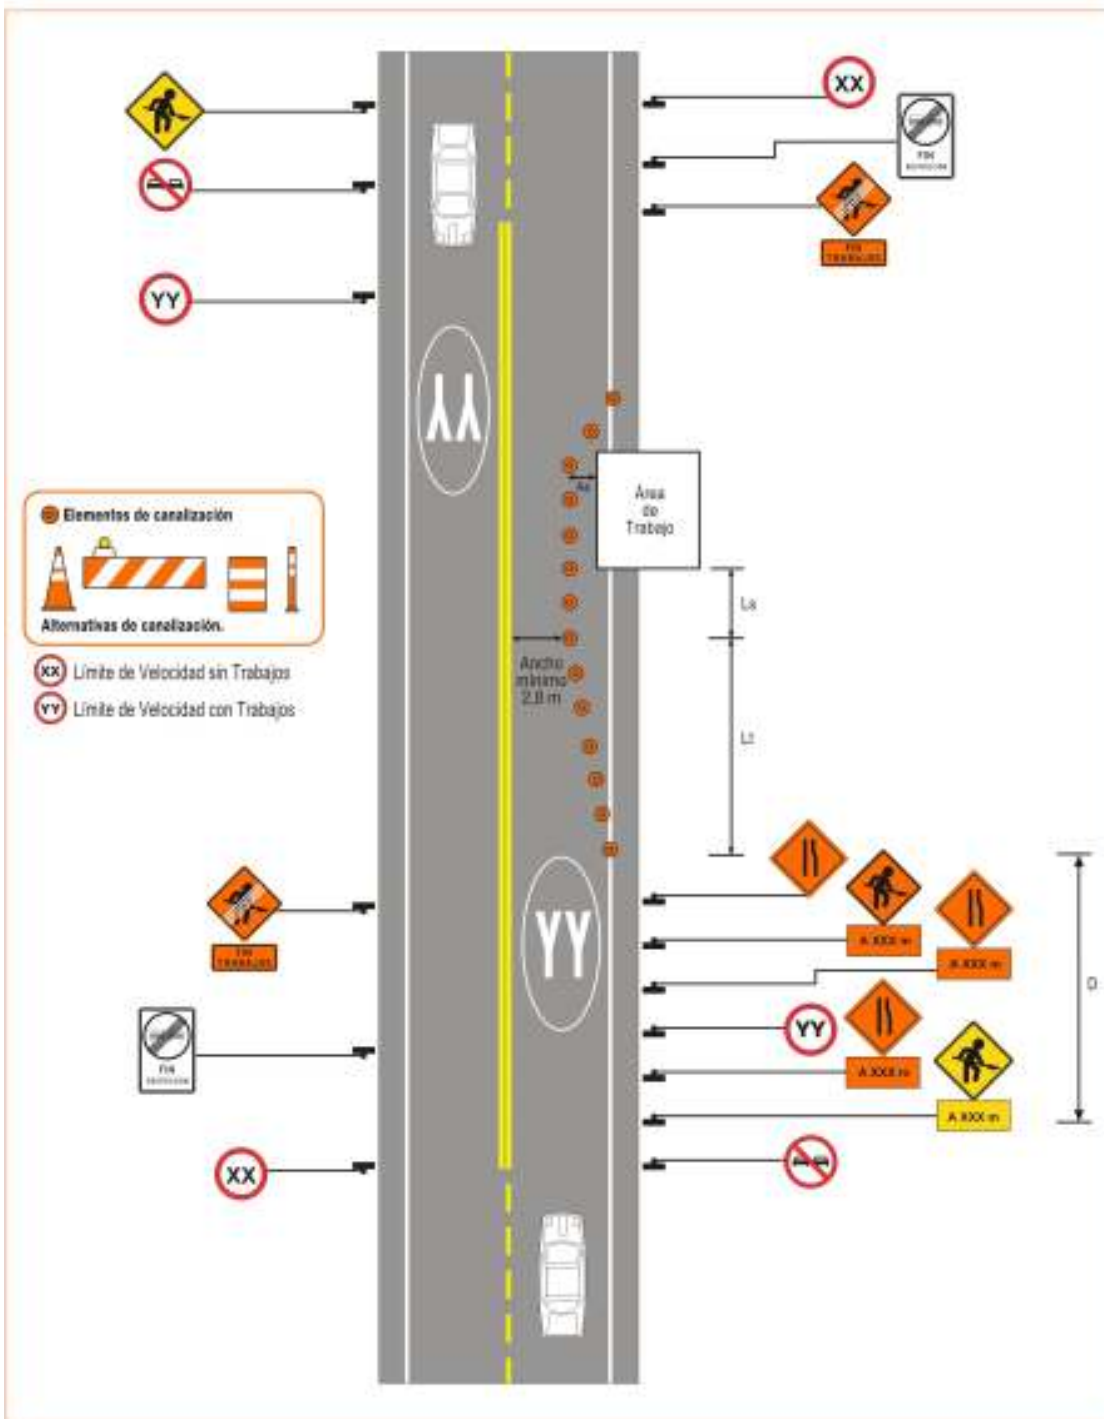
TRABAJO EN LA BERMA Y PISTA
